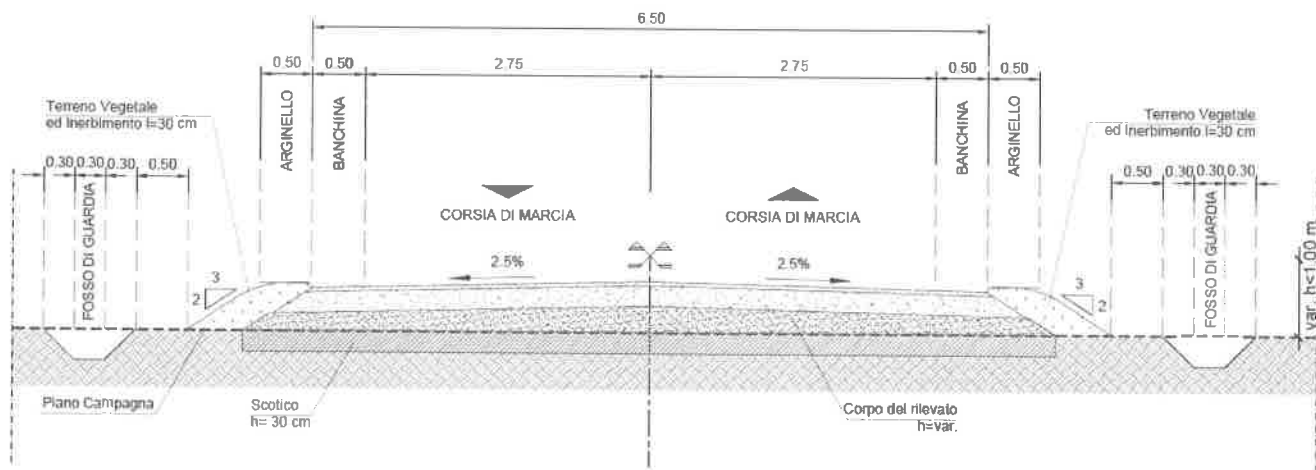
Sezione Tipo in Rilevato h < 1,00 m
